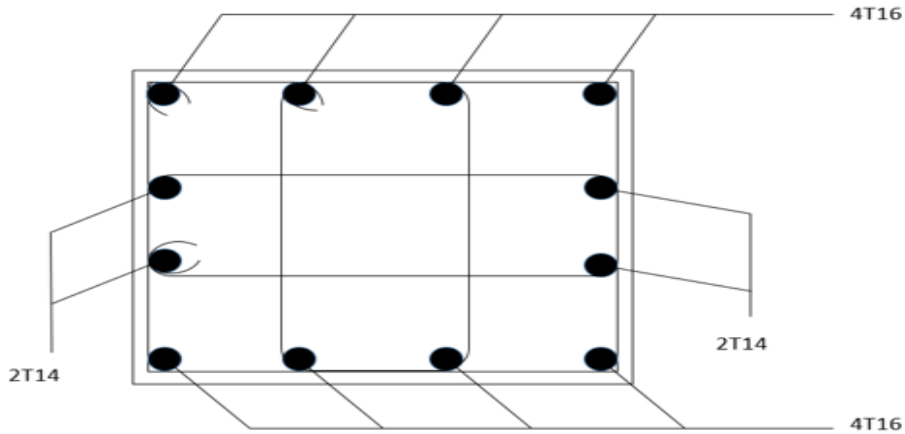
Schéma de ferrailage de la poteau (65 x 65) cm².
